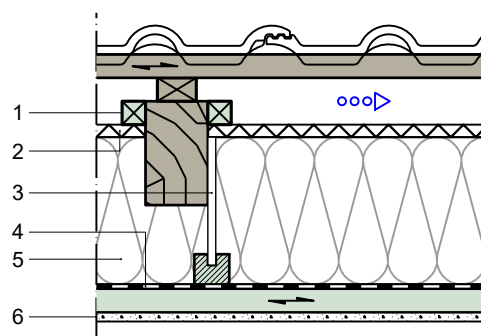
Dachaufbau mit vorhandener Konterlattung und diffusionsdichter Unterspannbahn (bleibt ggf. erhalten)
